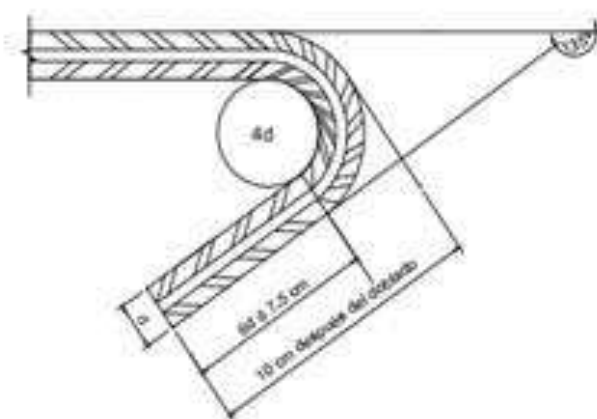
Geometría del gancho Longitud de doblado en estribos de 8 mm
